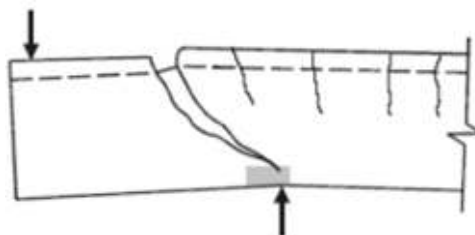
Ruptura por escorregamento das barras longitudinais tracionadas. (ACI-ASCE 426, 1973).
